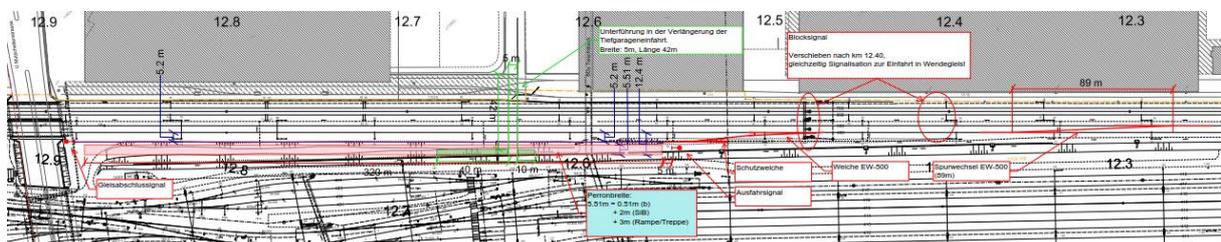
Ausschnitt Anlagelayout Variante 1.3
